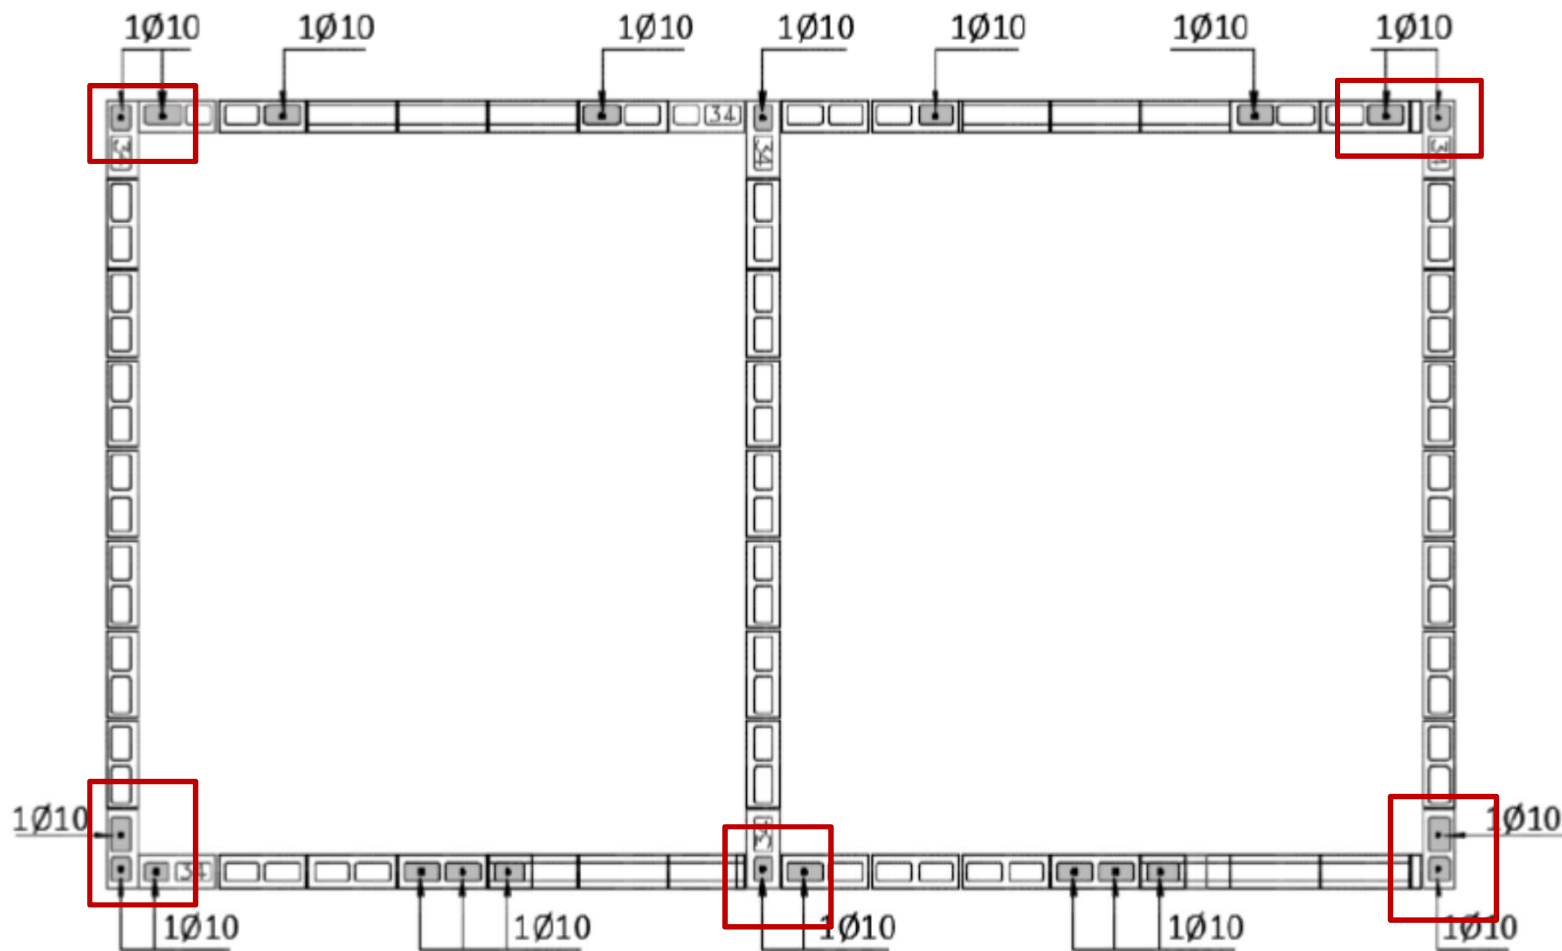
Posicionamento das armaduras verticais e graute.
